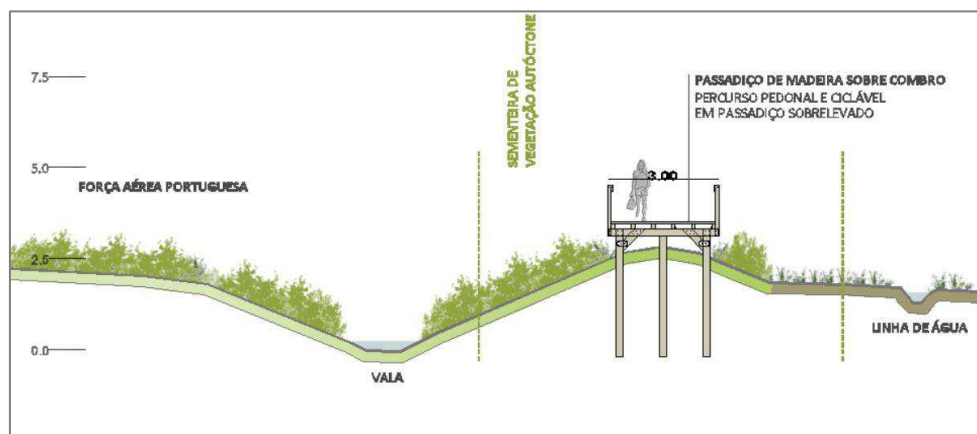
| Corte tipo - Implantação de passadiços sobrelevados em estrados de madeira em situações menos favoráveis altimetricamente
